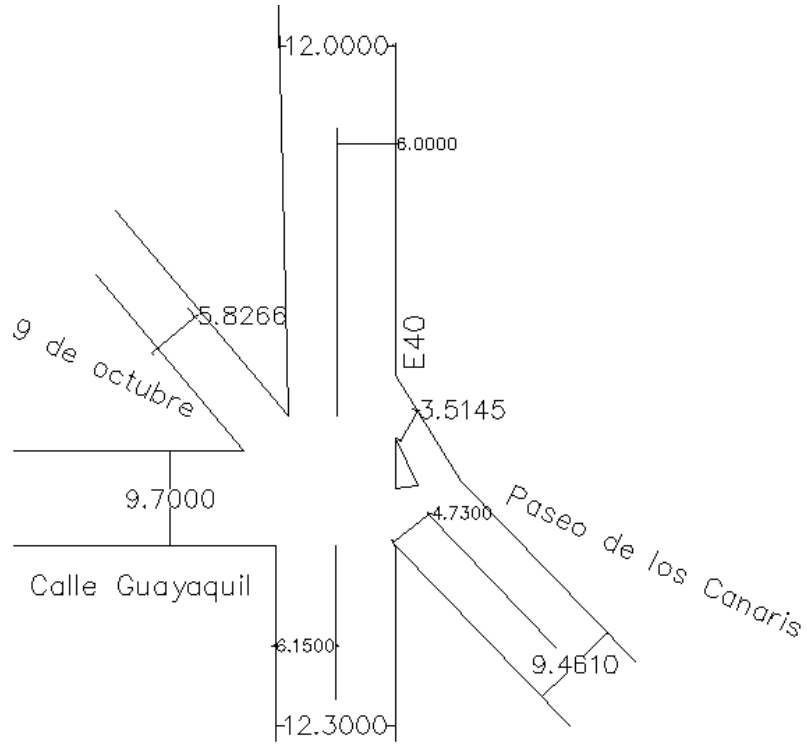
Geometría de la intersección 4. Fuente: Elaboración Propia
